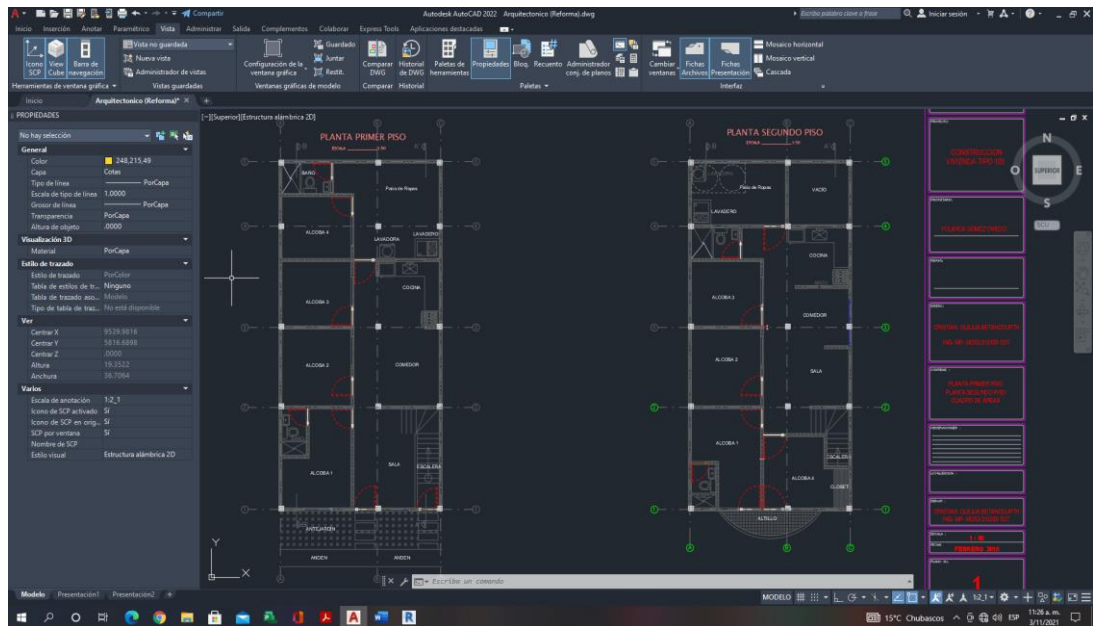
Plano primer y segunda planta. AutoCAD Fuente elaboración propia.
